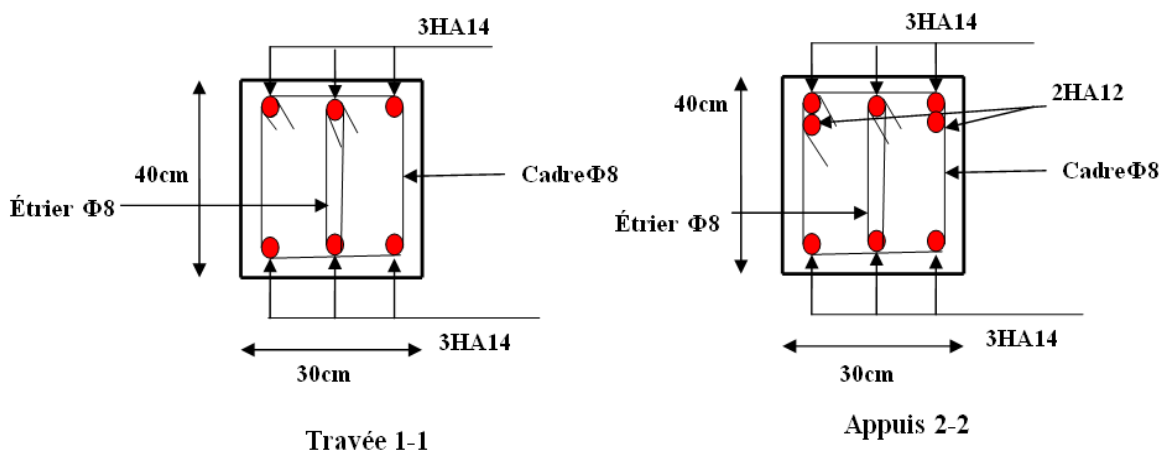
schéma de ferrailage de la poutre secondaire de l'étage courant
